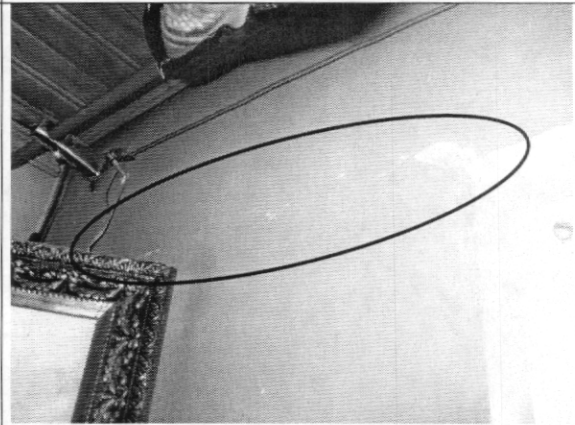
Agrietamiento horizontal en muro de fachada
